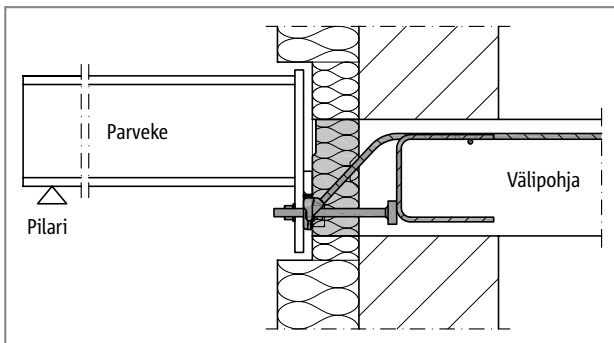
Schöck Isokorb® T tyyppi SQ: Pilareilla tuettu parveke
